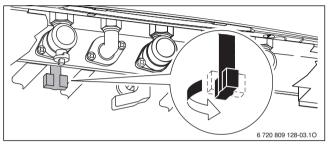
Rubinetto di riempimento con apparecchi ZWB
